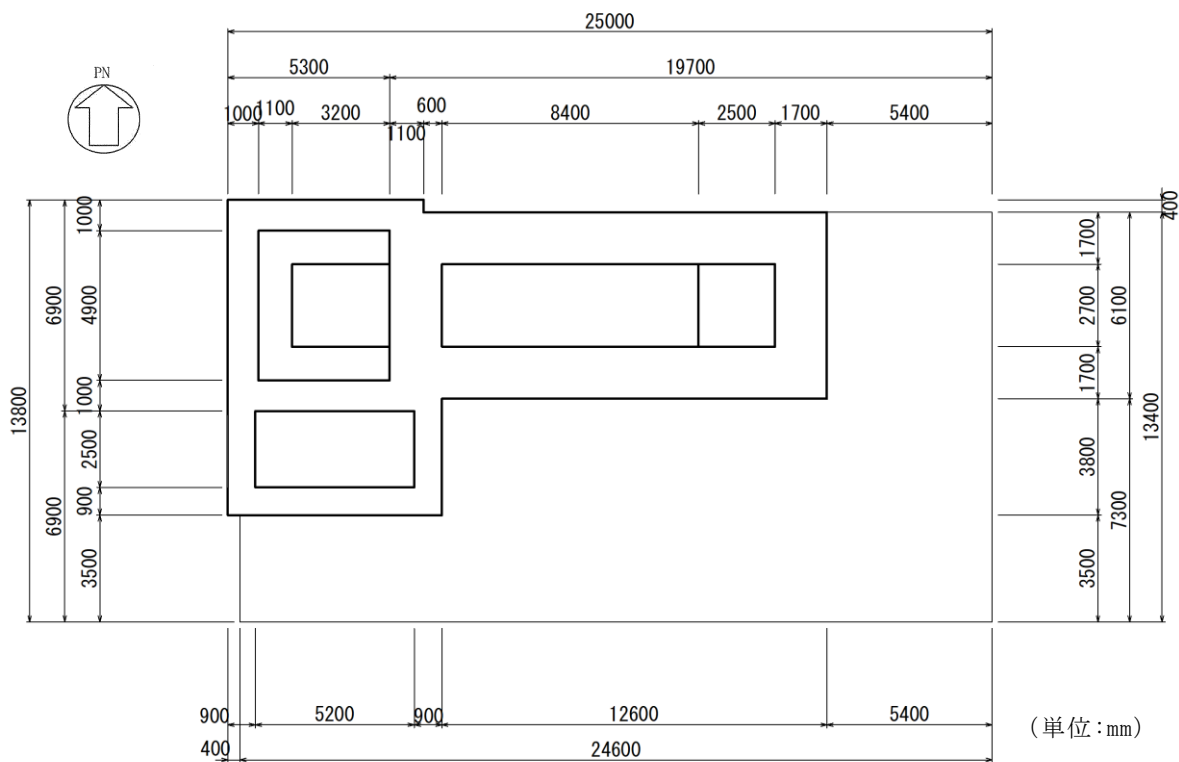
第 1 ベントフィルタ格納槽 平面図 (EL 16.00m)
